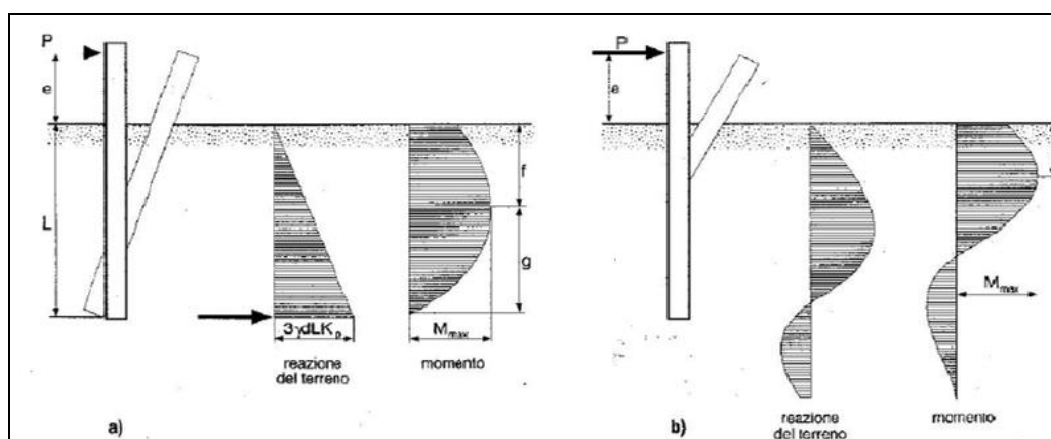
schematizzazione dell'azione del terreno su un palo infisso secondo Broms
